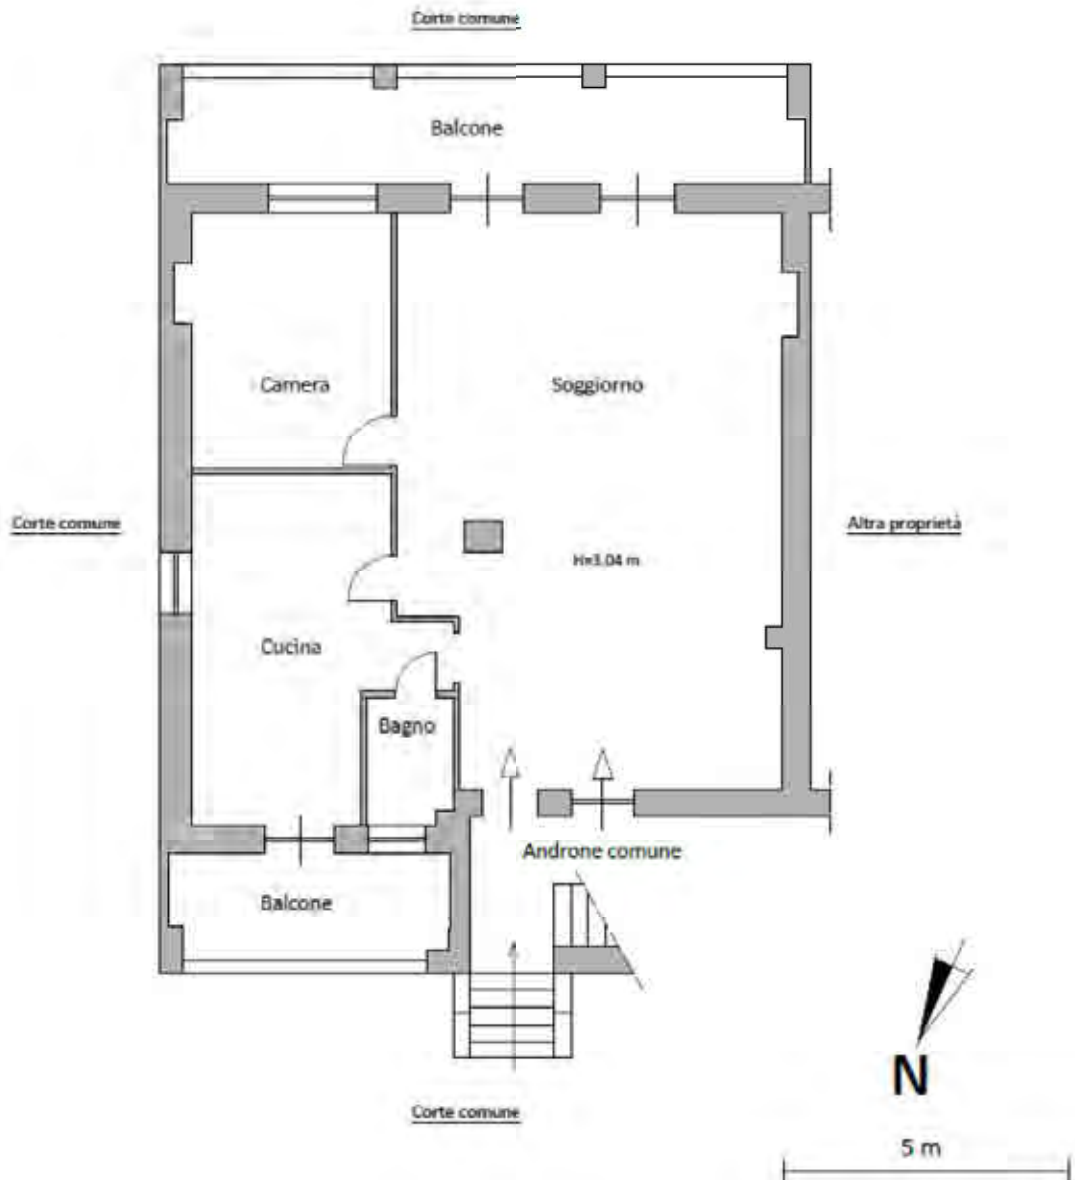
Planimetria dello stato reale dei luoghi – Piano Terra
